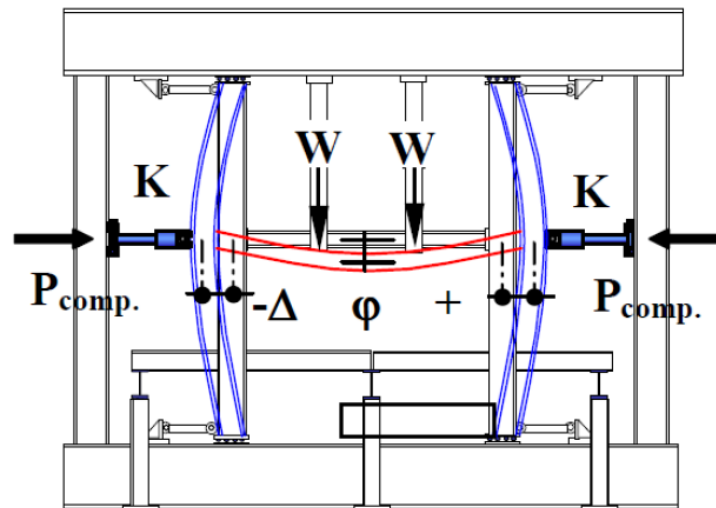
Expansão térmica da viga (ALLAM, BURGESS, & PLANK, 2002).
